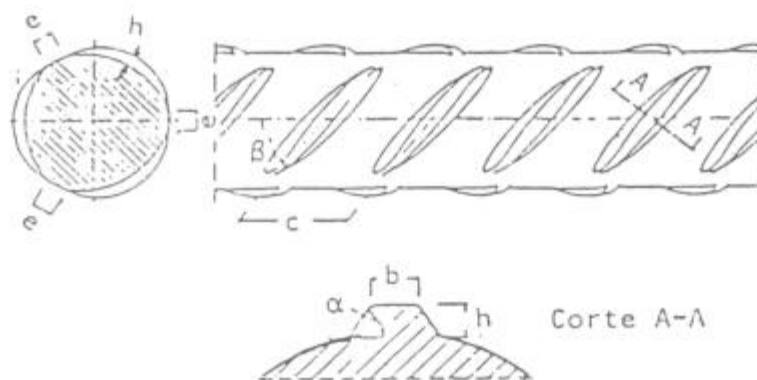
Alambre nervurado con tres filas de nervios transversales. Vista en planta y corte transversal.
